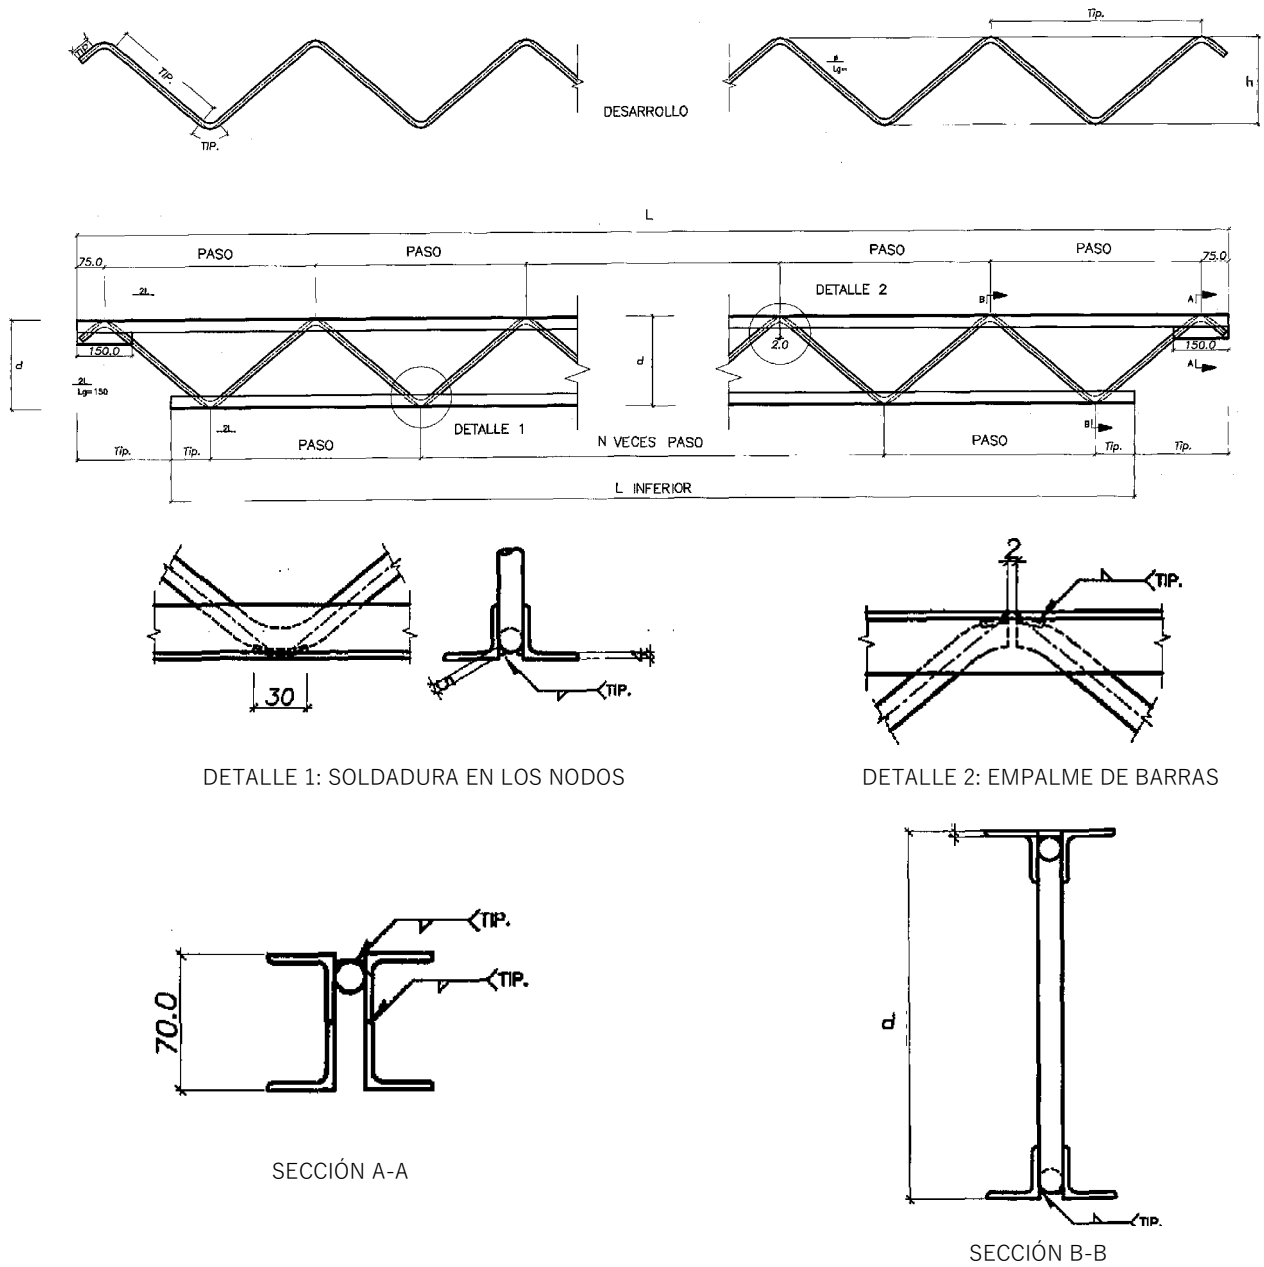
Plano de fabricación de Vigas JOIST de SIDETUR
